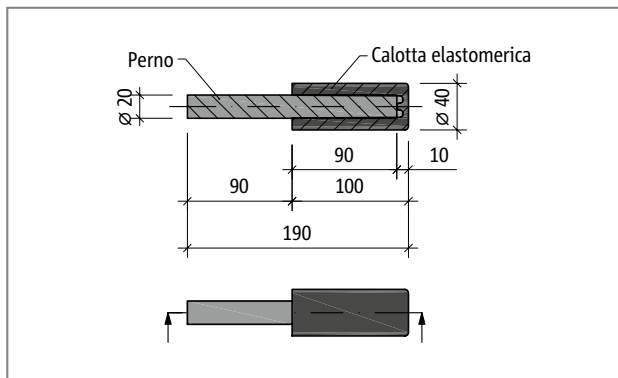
Schöck Tronsole® tipo D: pianta del prodotto
